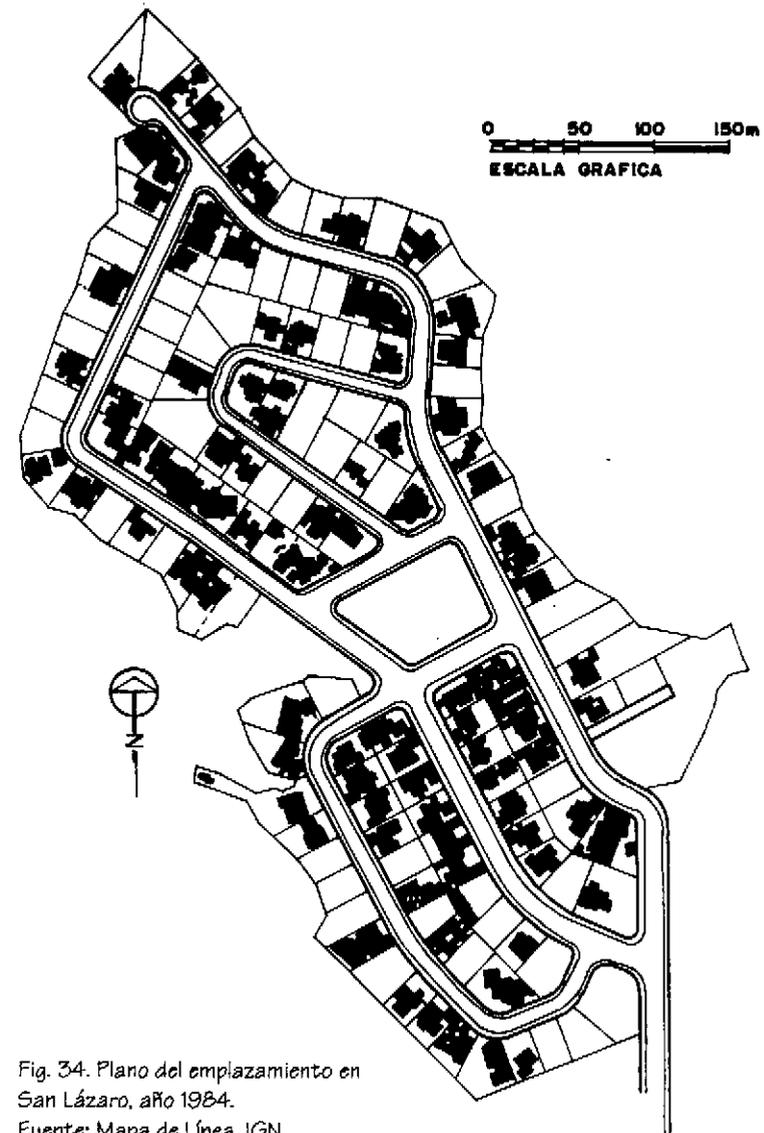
Plano del emplazamiento en San Lázaro, año 1984.
